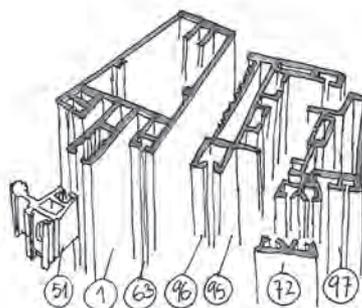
b Perfiles aluminio. Montante muro cortina y practicable
